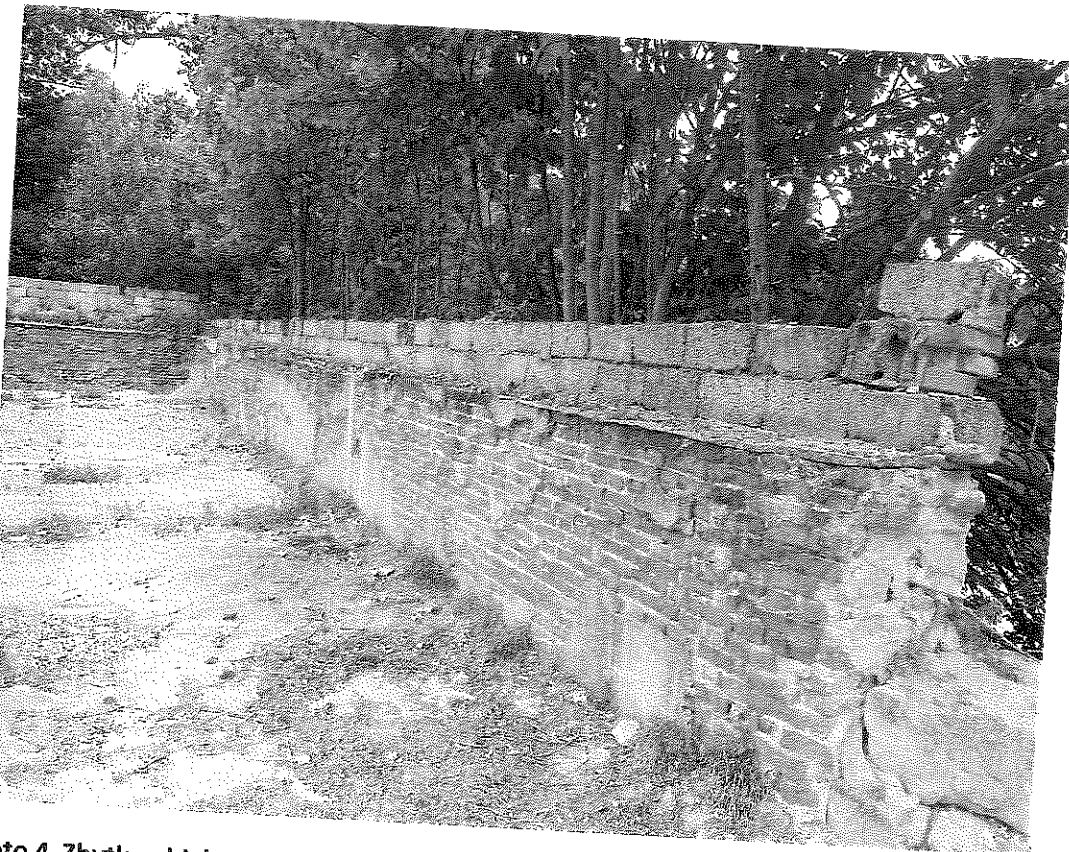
Zbytky objektu s nadezdívkou ze struskobetonových tvárnic
